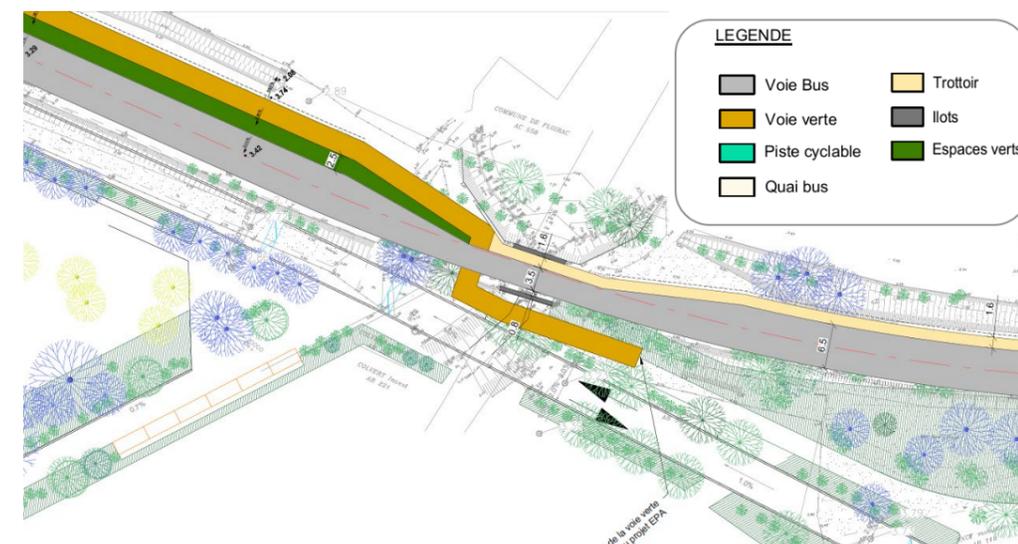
Plan projet au niveau de l'ouvrage d'art existant
